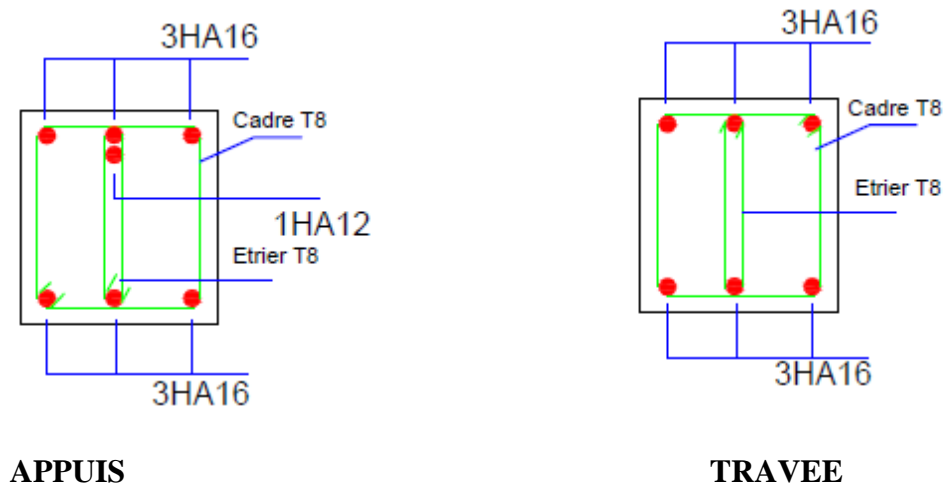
Schéma de ferrailage de la poutre principale du plancher ETAGE 2.
